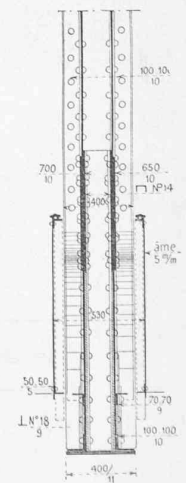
Colonne sur escalier. — Coupe en long au milieu.
